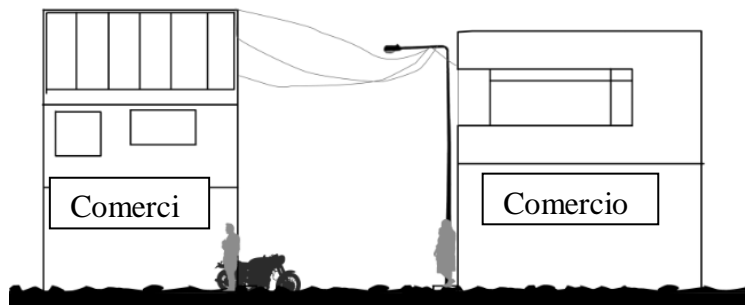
Caracolí, Esquema sección calle sin pavimento. Morfología.
